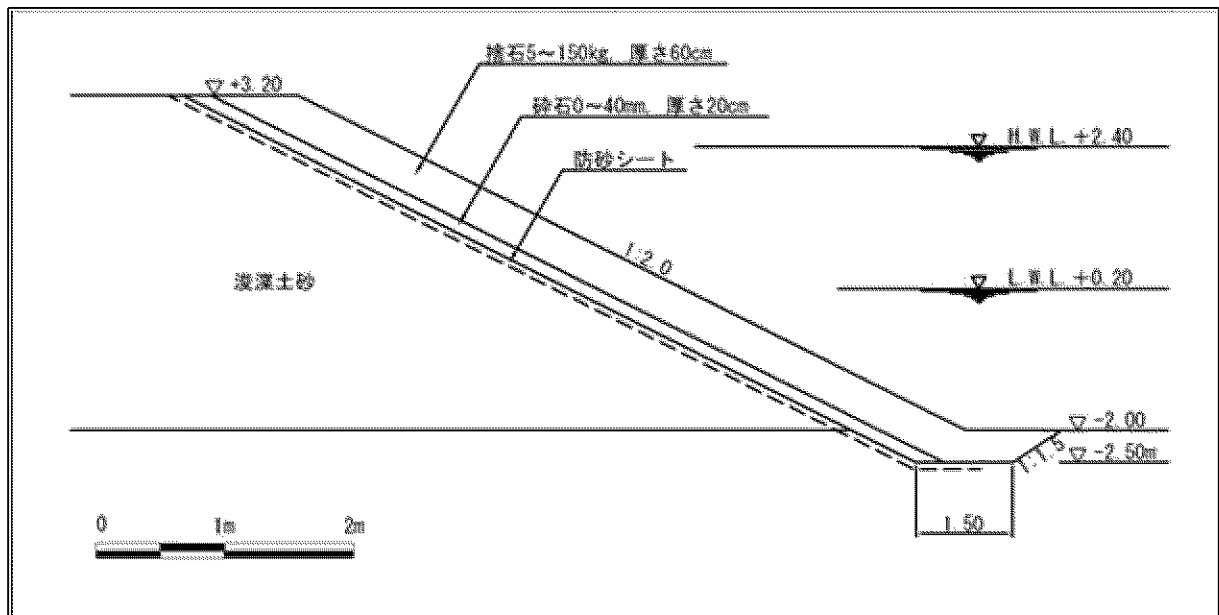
(18-1) 護岸の標準断面図 (護岸 A : 係留栈橋の陸側)
